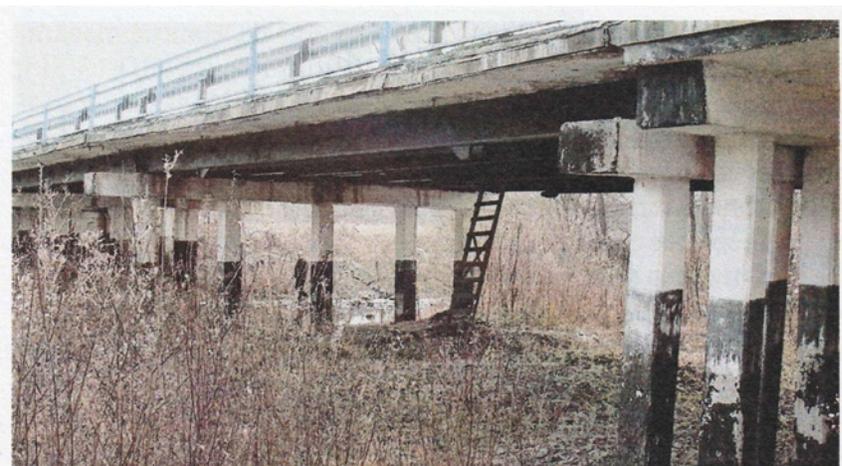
На нижнем поясе крайней балки видны упоры для стеклопластиковой арматуры.
